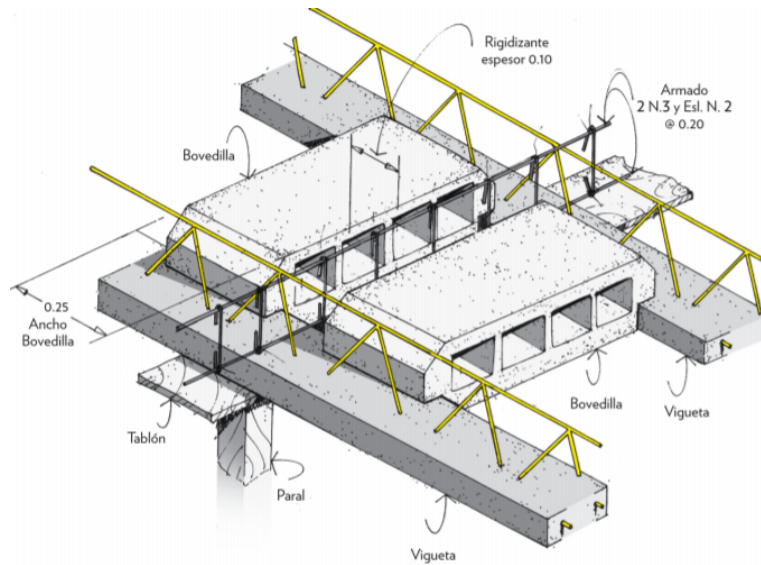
Detalle constructivo de una losa de vigueta y bovedilla [9]
